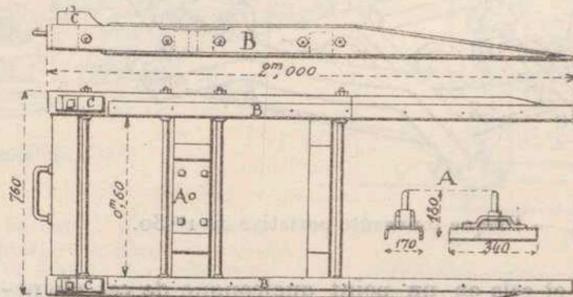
à 26. Élévation et plan de la sauterelle; détail du pivot.
